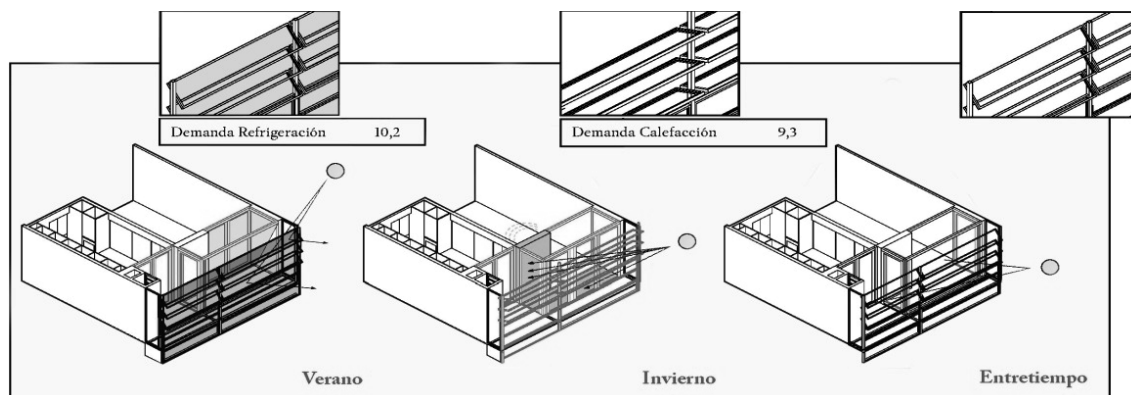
Estudio de las demandas con el movimiento de la galería en la fachada sur planta 4ª central
